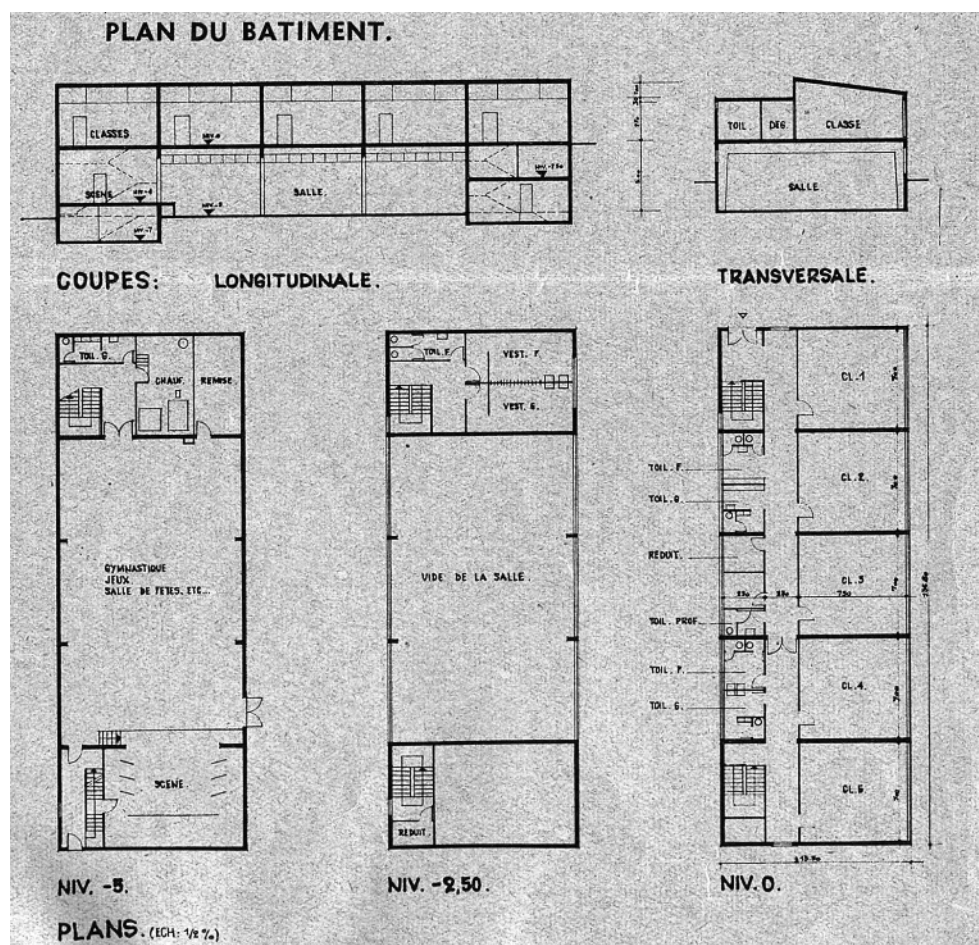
Grundriss des Neubauprojekts (1961) (CED, Brochures, Nous Bâtissons, 1960)
